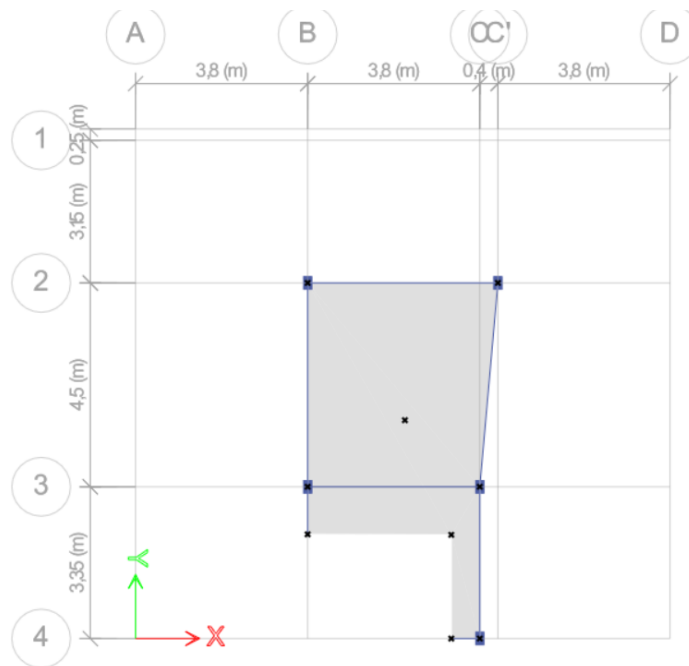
Planta arquitectónica de Terraza de la edificación en AutoCAD
